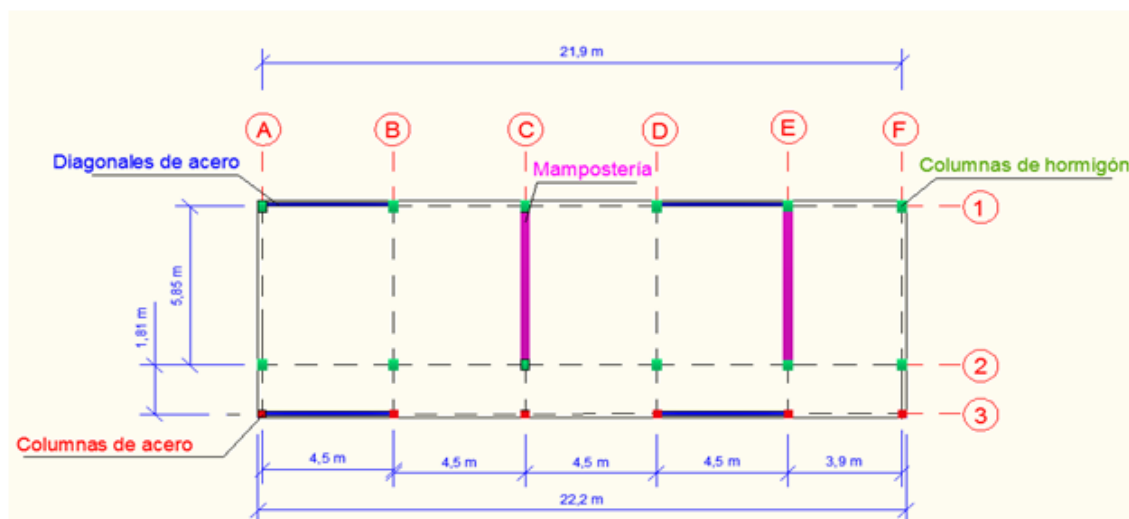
Propuesta 1: Columnas de acero en voladizo y diagonales de acero
